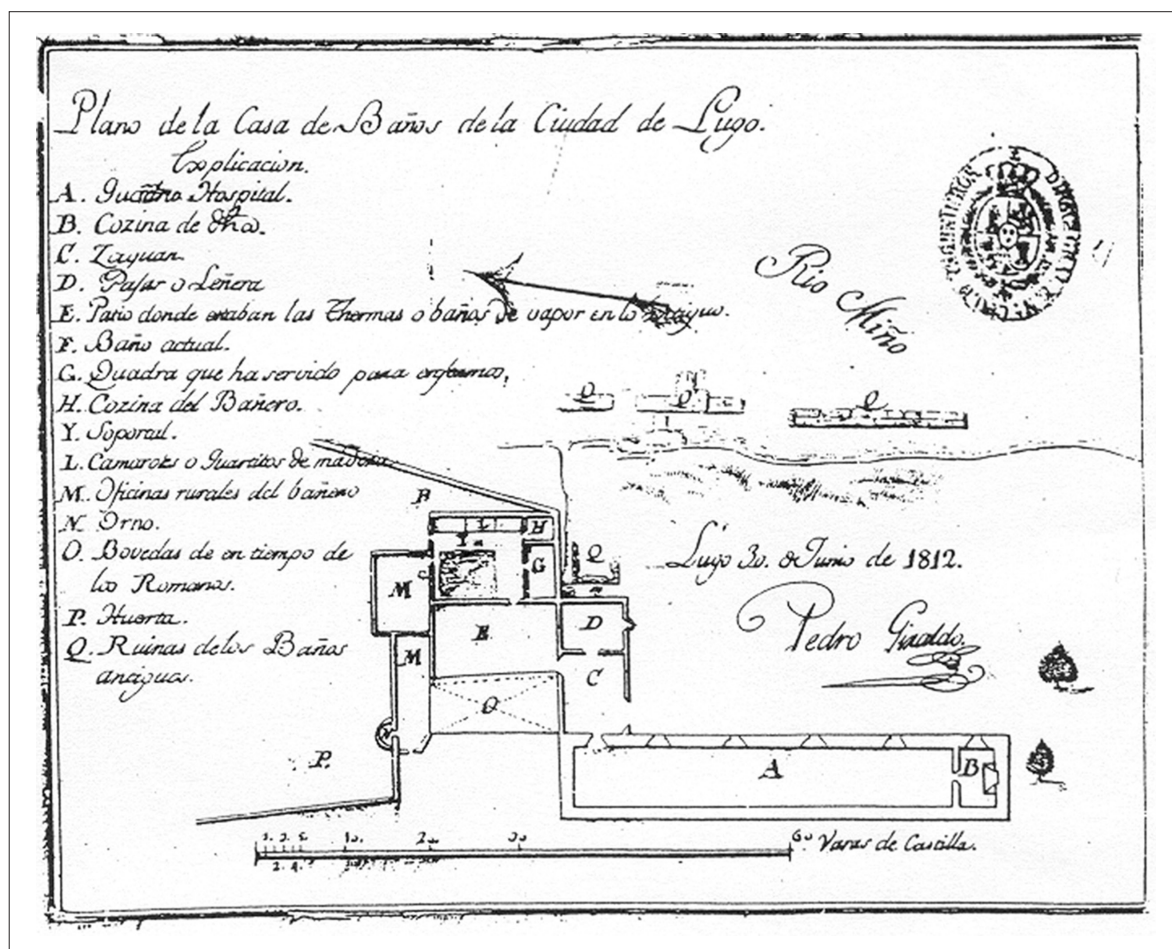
Planta del balneario anterior a la construcción del edificio moderno, del ingeniero P. Giraldo (1812).
